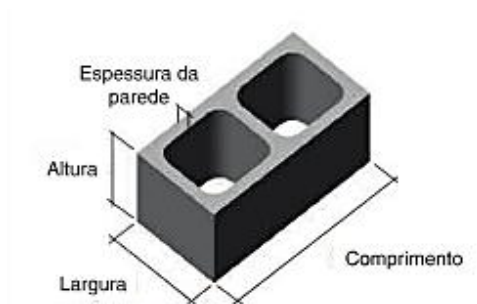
Modelo de bloco vazado de concreto simples para alvenaria de vedação (ABNT NBR 6136:2014).
